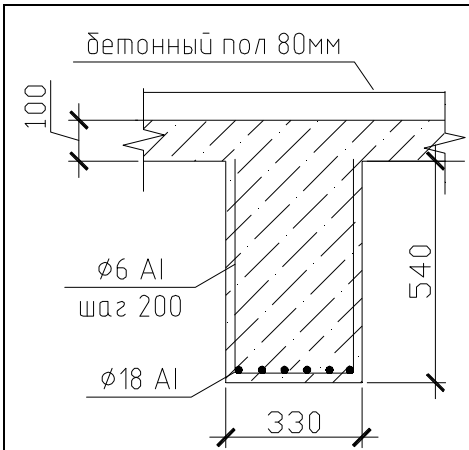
Главная балка ж/б перекрытия над вторым этажом в осях «3-б/В-Е»
